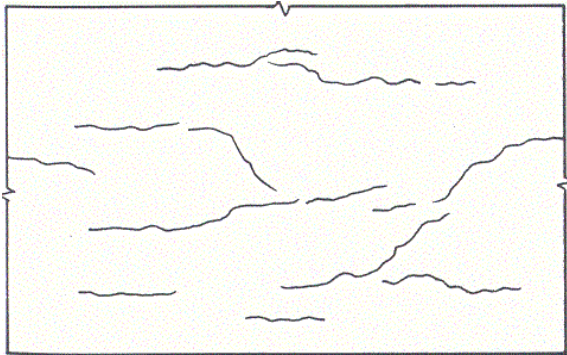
Fisuras Típicas por Contracción Plástica en una Superficie Plana.
